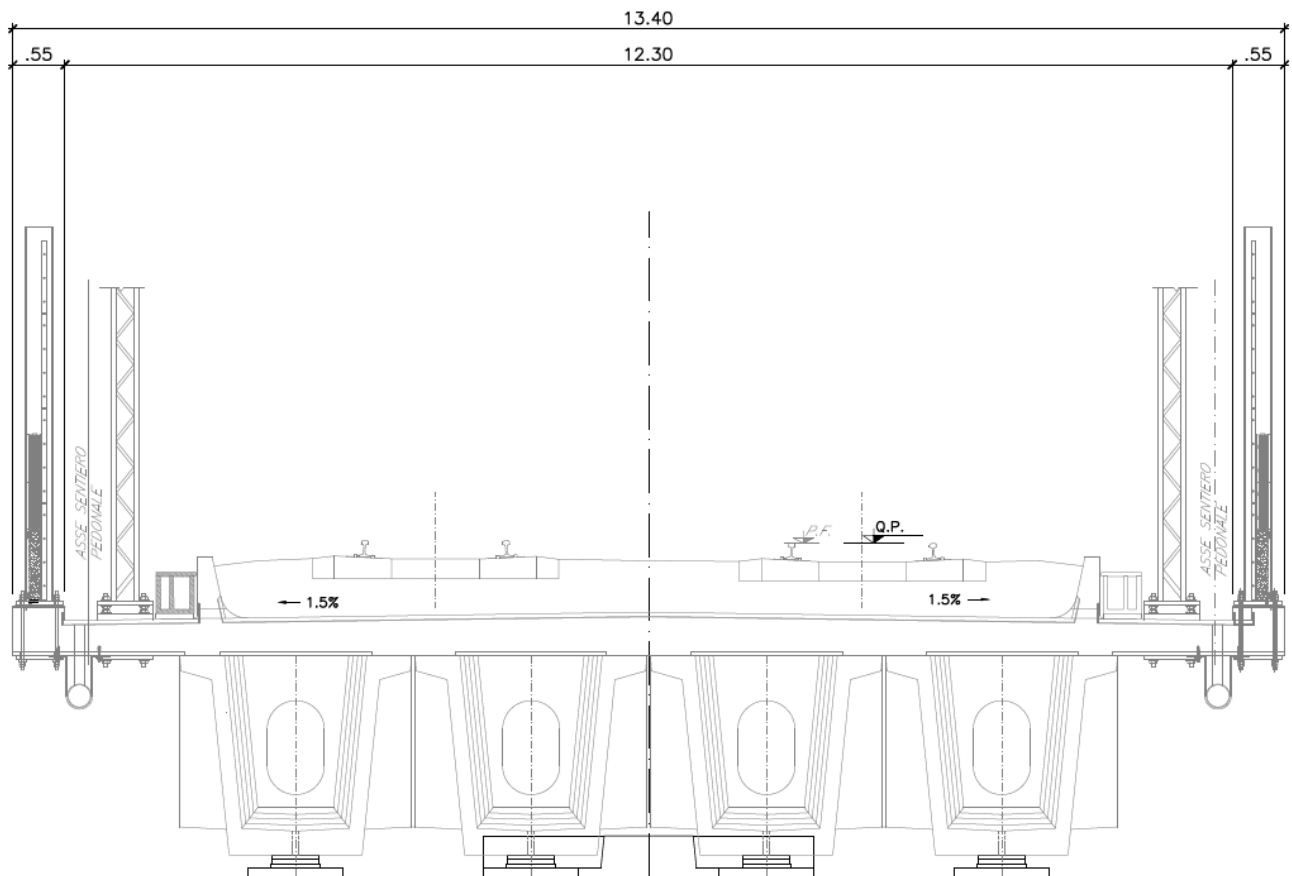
Sezione tipo - trasversale impalcato con travi c.a.p.
